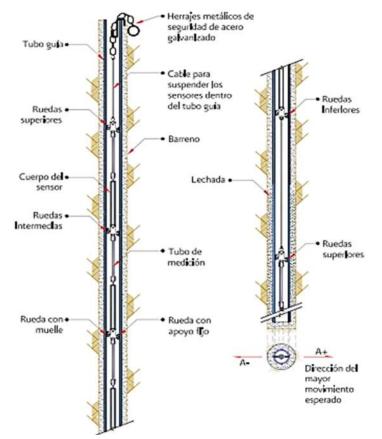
III.3.3.2.2 Sensor en serie y sondas para inclinómetro vertical fijo.
